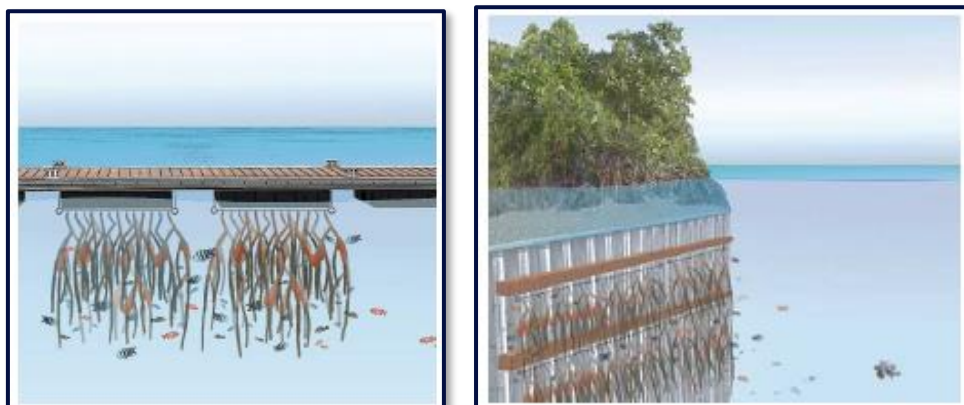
Structure racinaire suspendue aux pontons et quais flottants (gauche) et structure en latéral sur la retenue en palplanches (droite)
